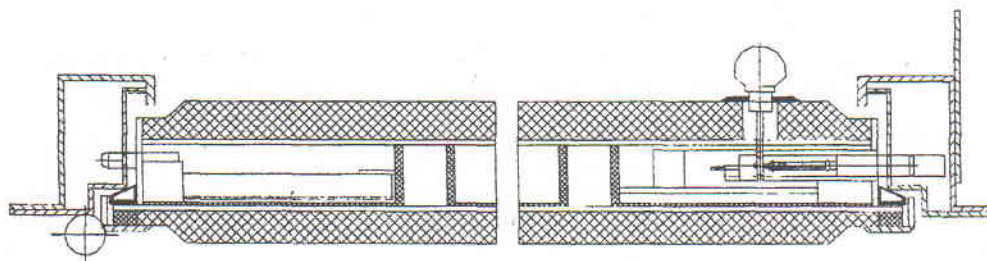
Пример конструкции дверного блока, сваренного из стальных листов и профилей, с облицовкой из натуральной древесины
